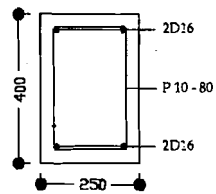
Detail Tulangan Balok Induk BA2 As K' Lt 4
